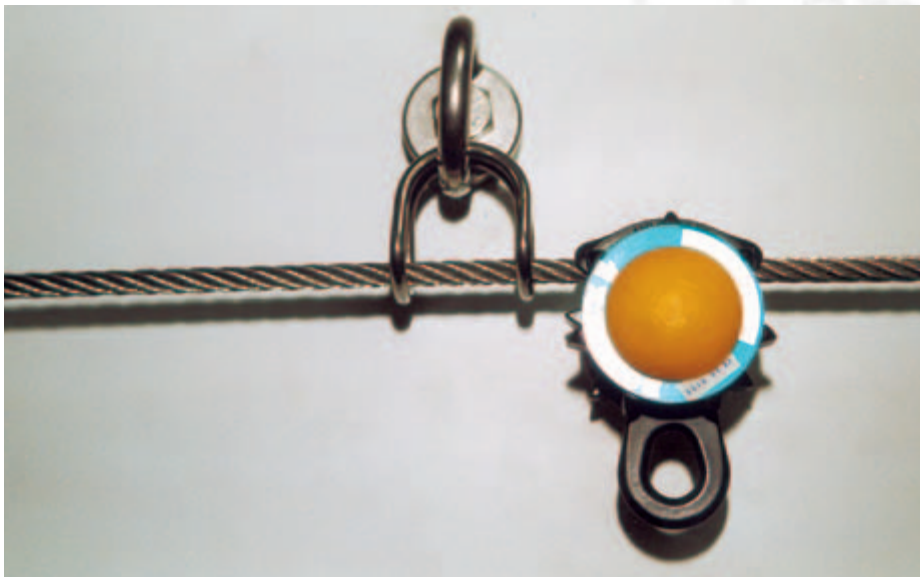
Anschlagvorrichtung mit einem beweglichen Anschlagpunkt, Beispiel 2
